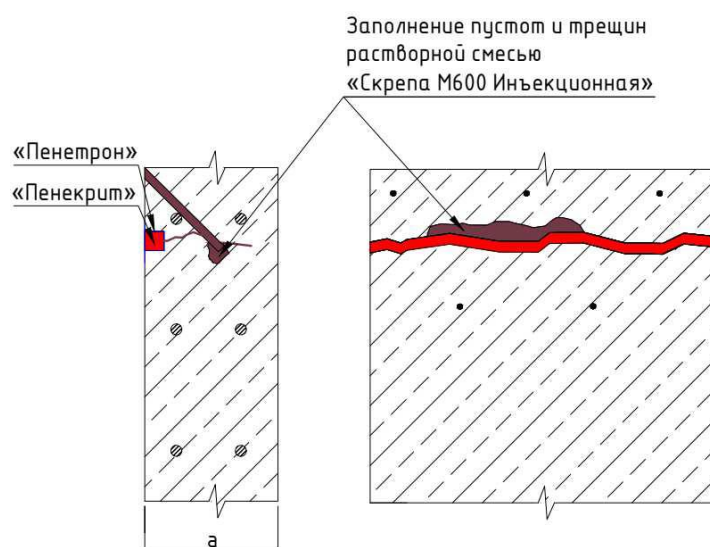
Схема заполнения пустот и трещин в монолитной бетонной стене
